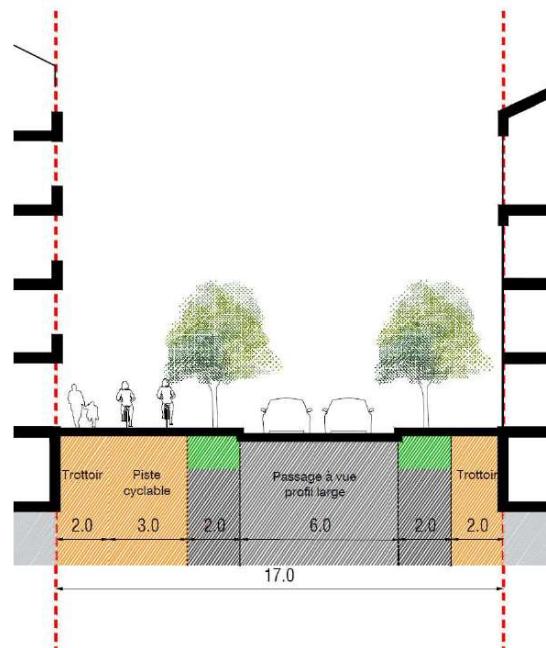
Coupe de principe sur la voie centrale – gabarit 17 m
